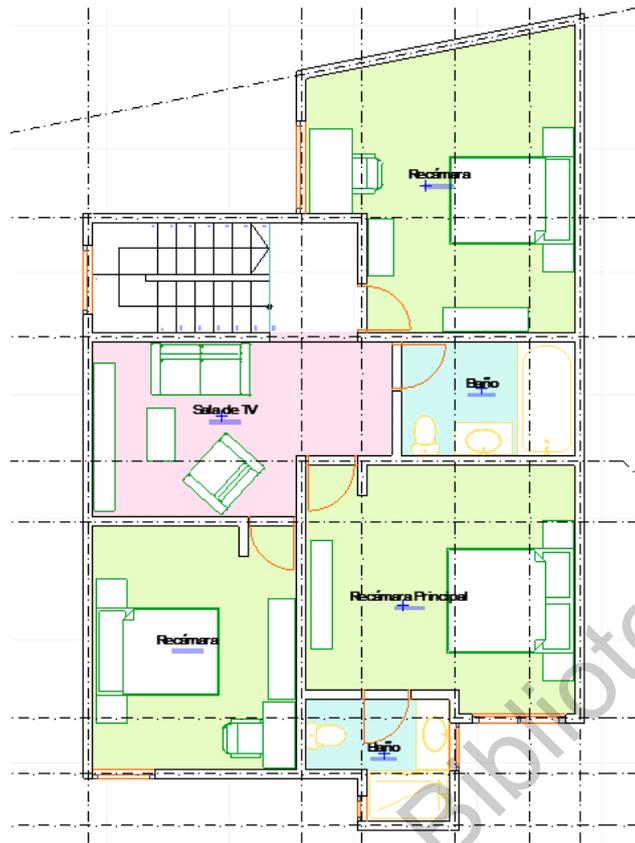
Zonas/Habitaciones en Planta alta del proyecto 001.
